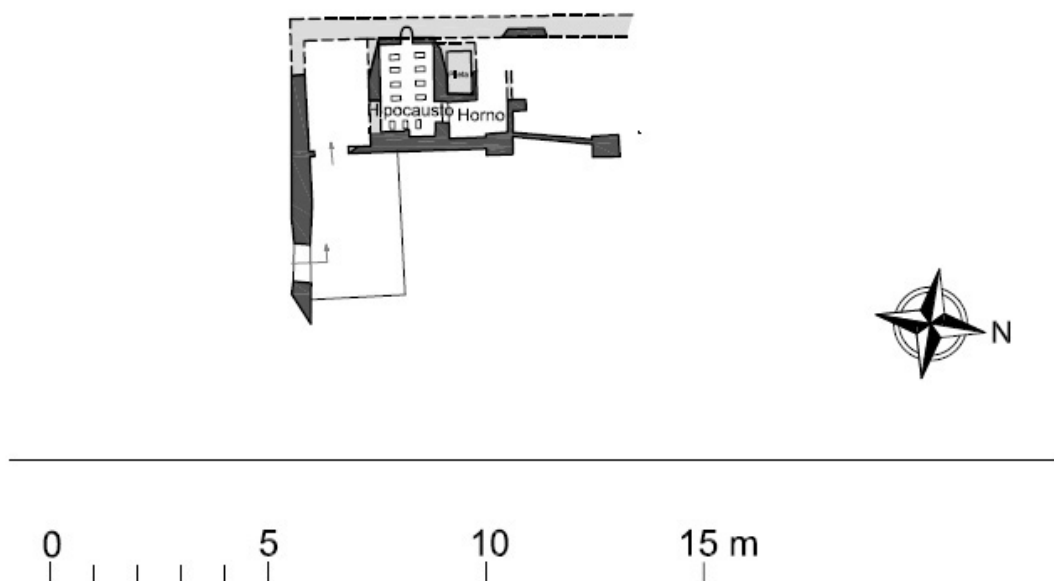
Baño de Polo de Medina. Croquis de la planta
